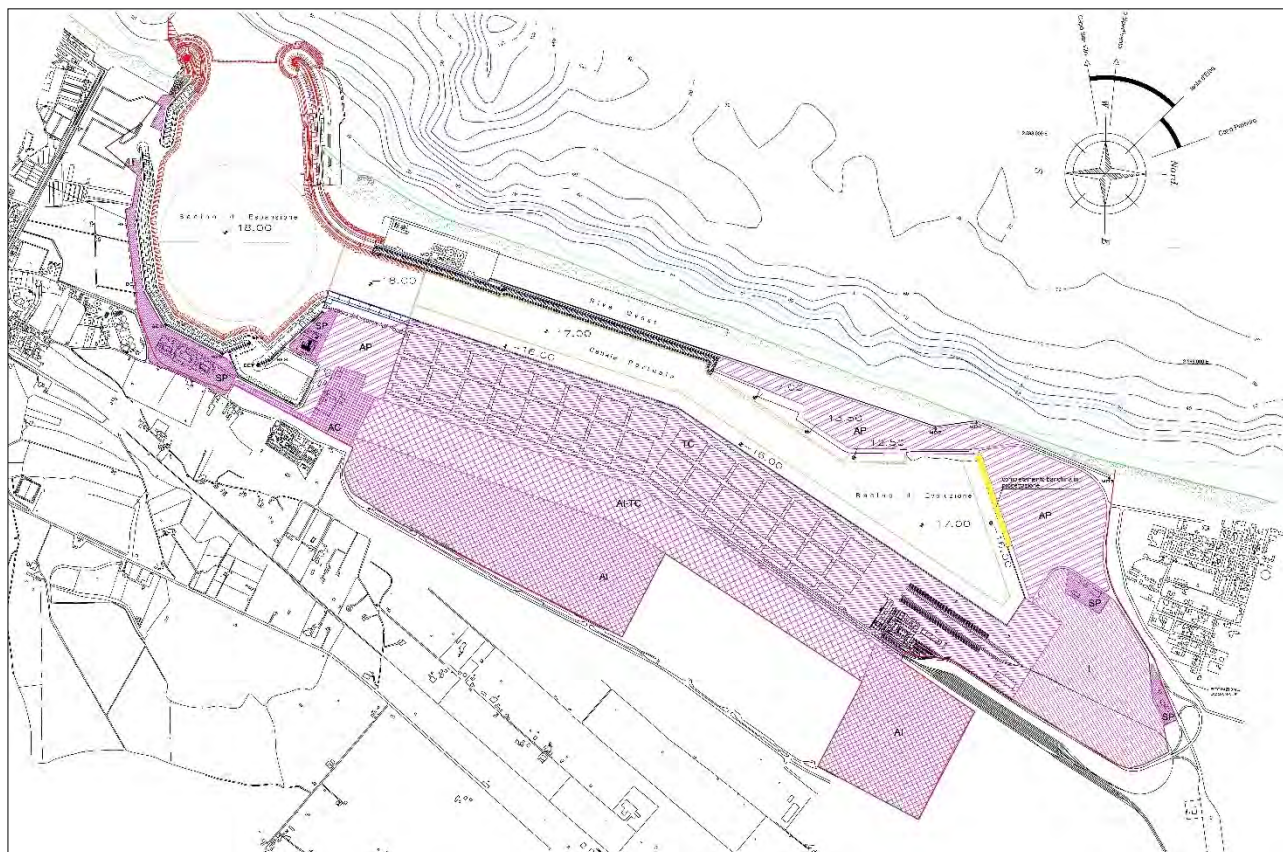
Stralcio ATF 2005 – Planimetria piano pescaggi
